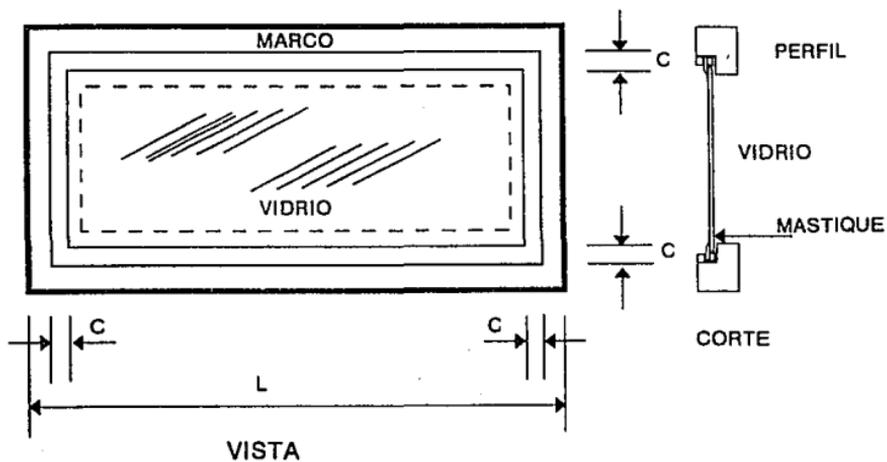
HOLGURAS ENTRE VIDRIO Y MANGUETE
